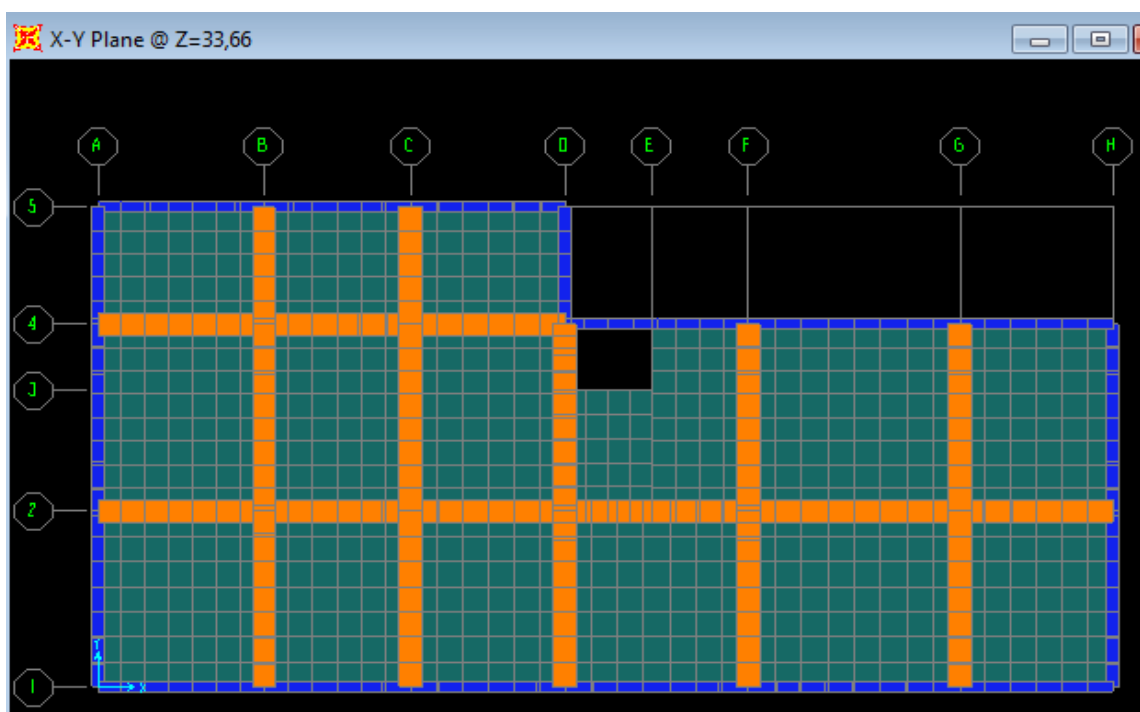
plancher en dalle pleine (terrasse inaccessible)
